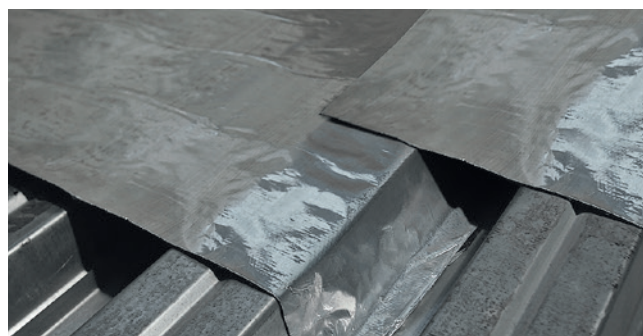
Формирование продольного нахлеста пароизоляции на профлисте
